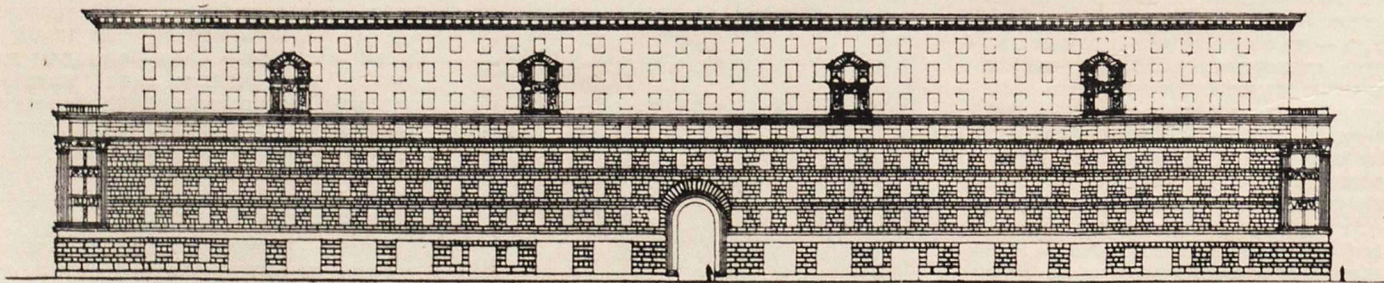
Жилой дом на Большой Калужской улице. Схема фасада
